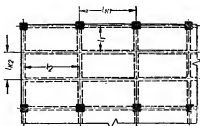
Схема ребристого монолитного железобетонного перекрытия.
